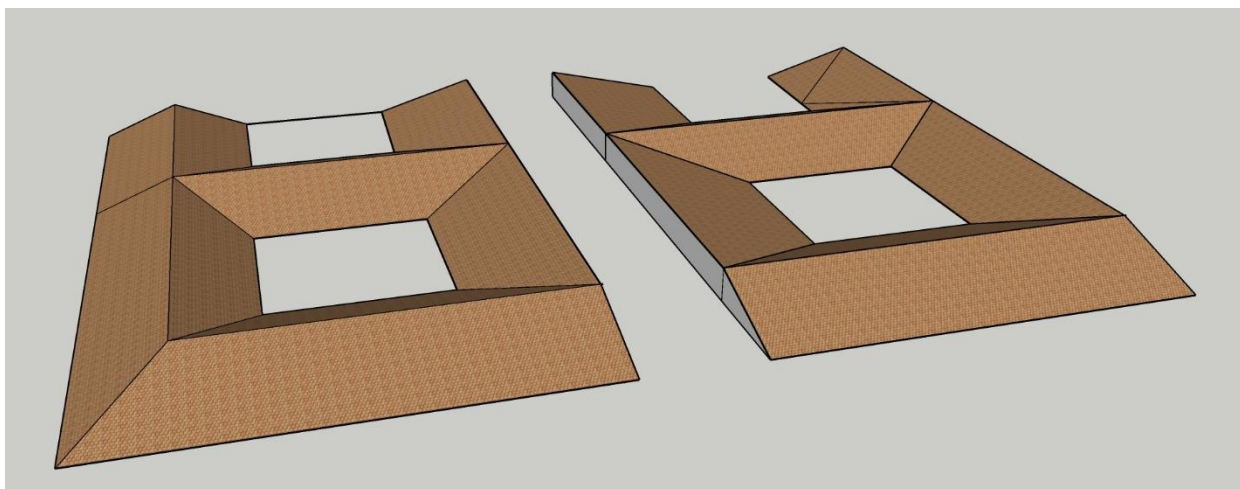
Cubierta actual – Cubierta propuesta. Fuente: Propia
